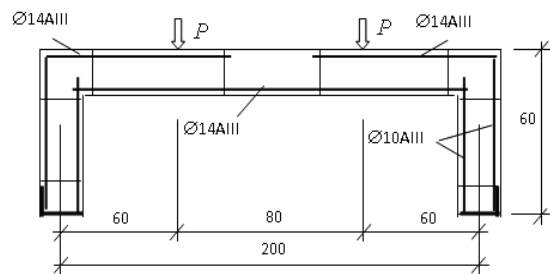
Схематичний вигляд П-подібної рами / A schematic view of P-like frame
